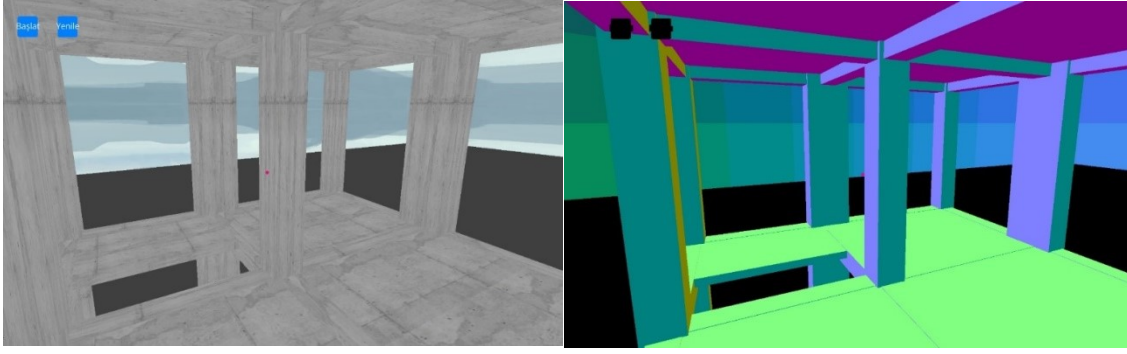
A yapısının beton dokulu 3B Modeli
